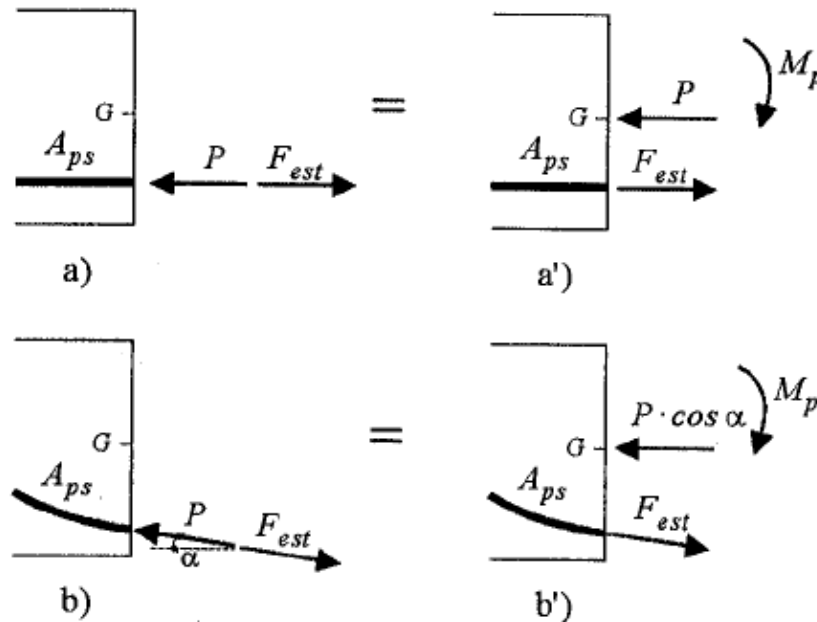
Esquema del pretensado en elementos estructurales con armadura postesa: (a) Fase pre; (b) Manera alterna para expresar la fase pre.
